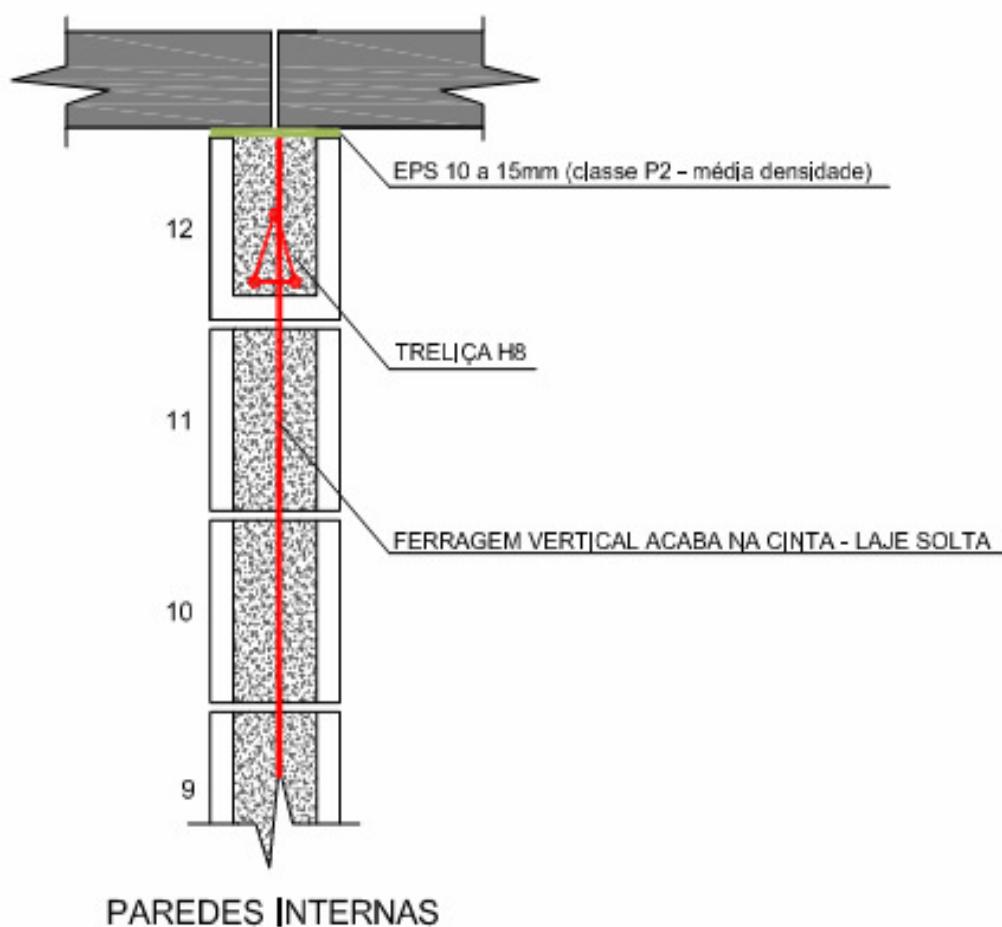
detalhe do apoio das lajes pré-fabricadas em paredes internas
